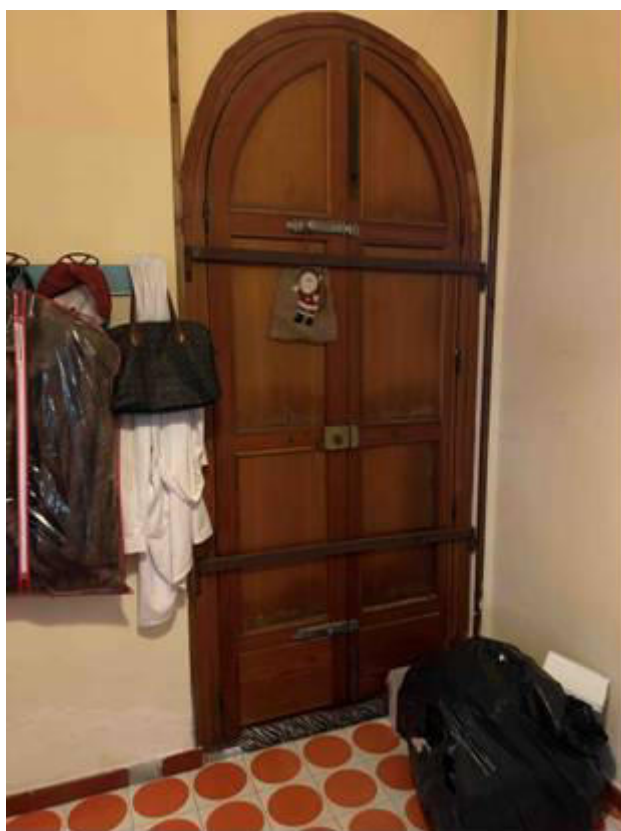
Foto scattata dall'interno dell'immobile al portone di ingresso secondario. Buone le condizioni.
